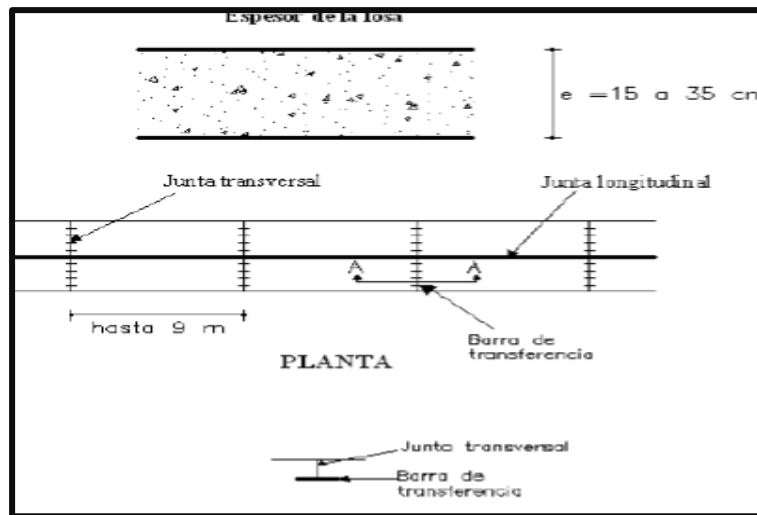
; Corte A-A. Sección de Concreto Hidráulico con Pasadores
